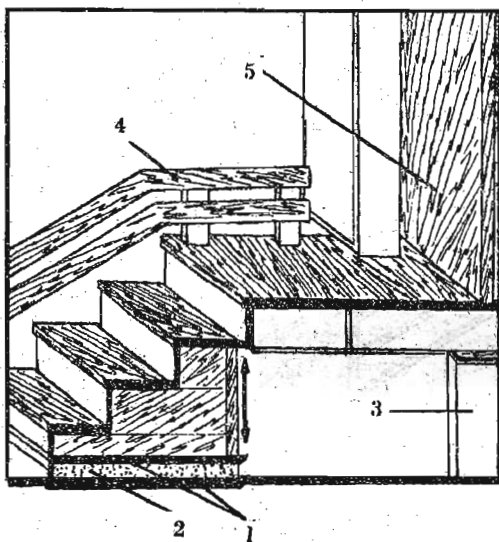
Наружная лестница у крыльца на косоурах (1-й вариант).
